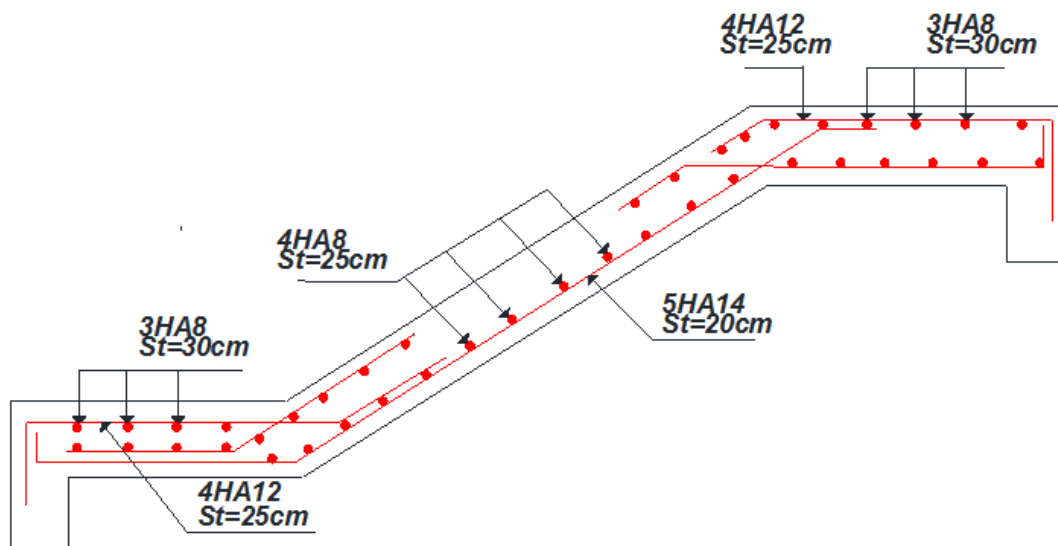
Schéma de ferrailage d'escalier type 1 et type 2
